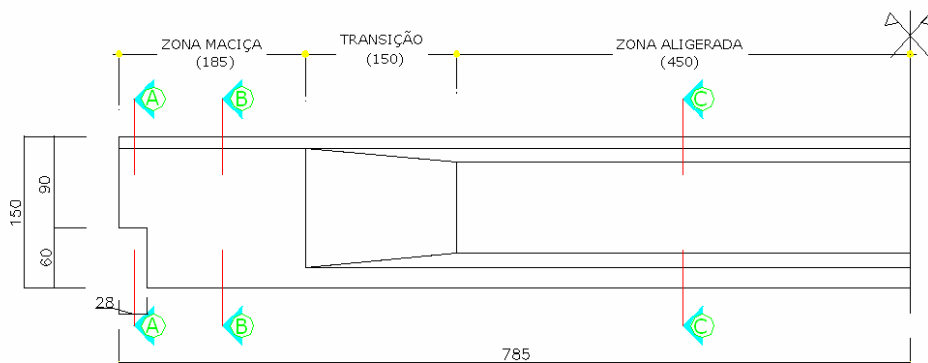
Alçado da viga pré-fabricada (dimensões em cm, sem escala)
